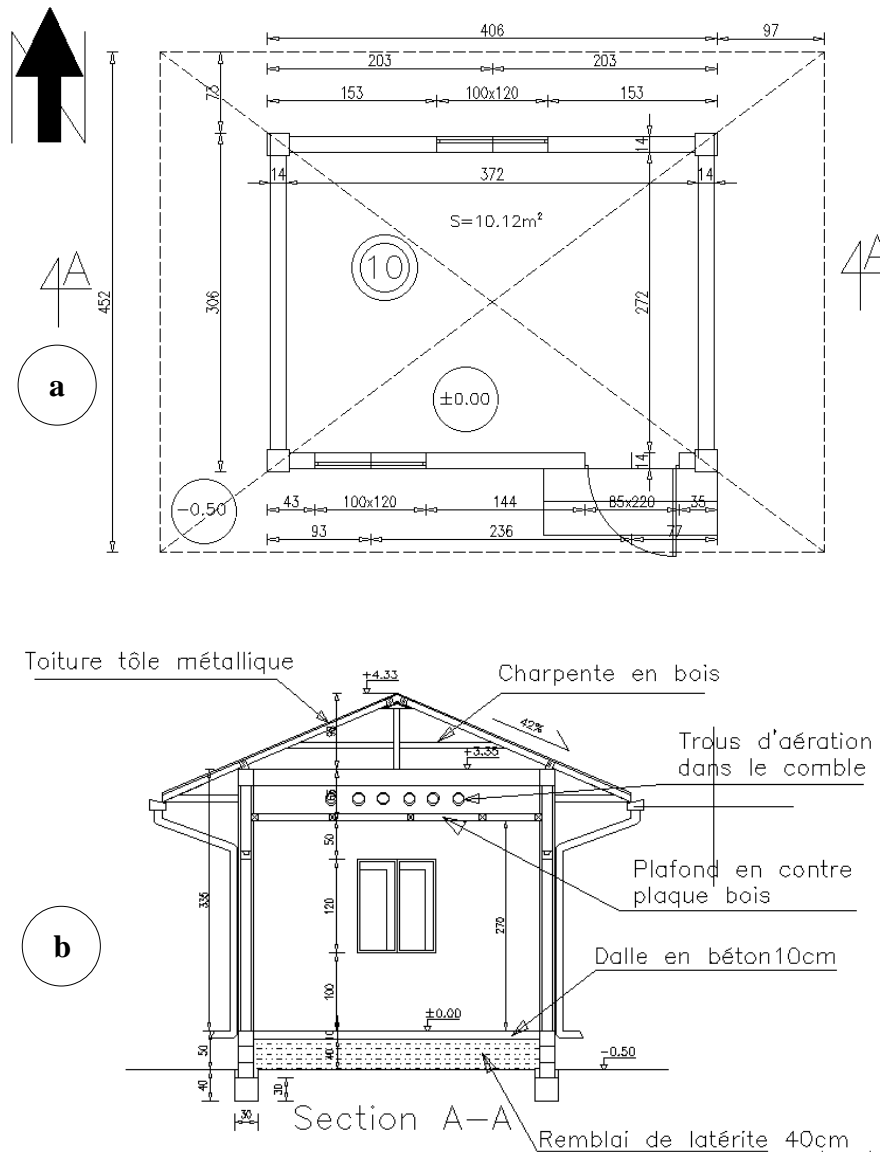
Plans des bâtiments pilotes a) vue de dessus b) coupe verticale
